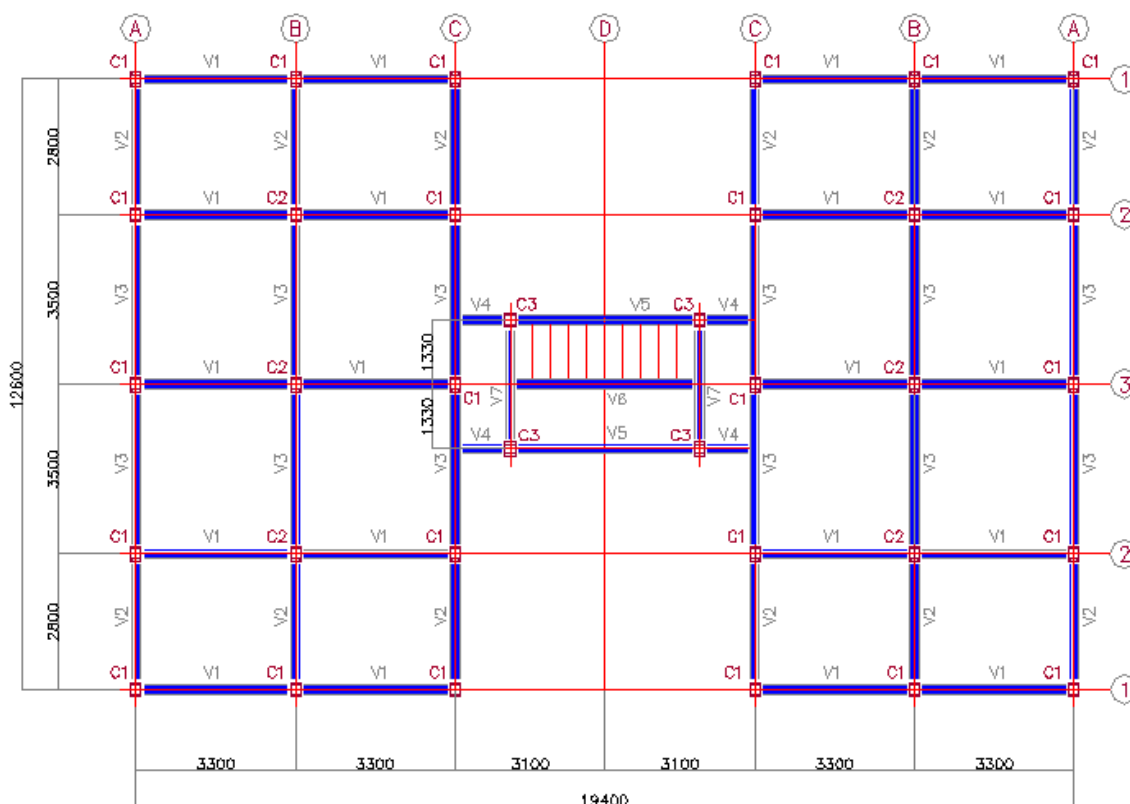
Plano de vigas do Pavimento tipo do modelo tipo “A” no sistema aporticado
